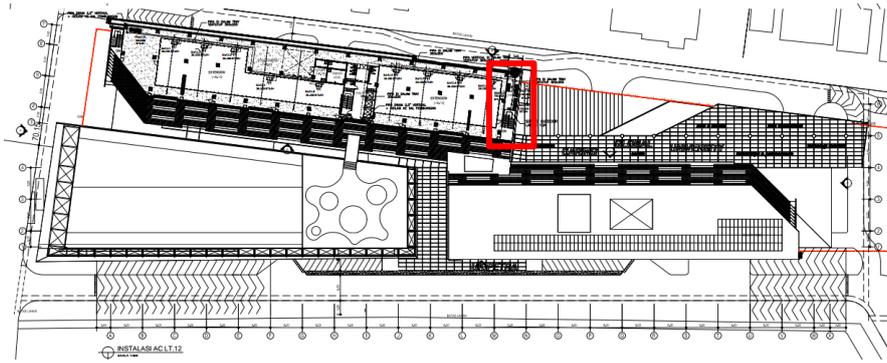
Denah posisi outdoor vrv pada lantai 8
